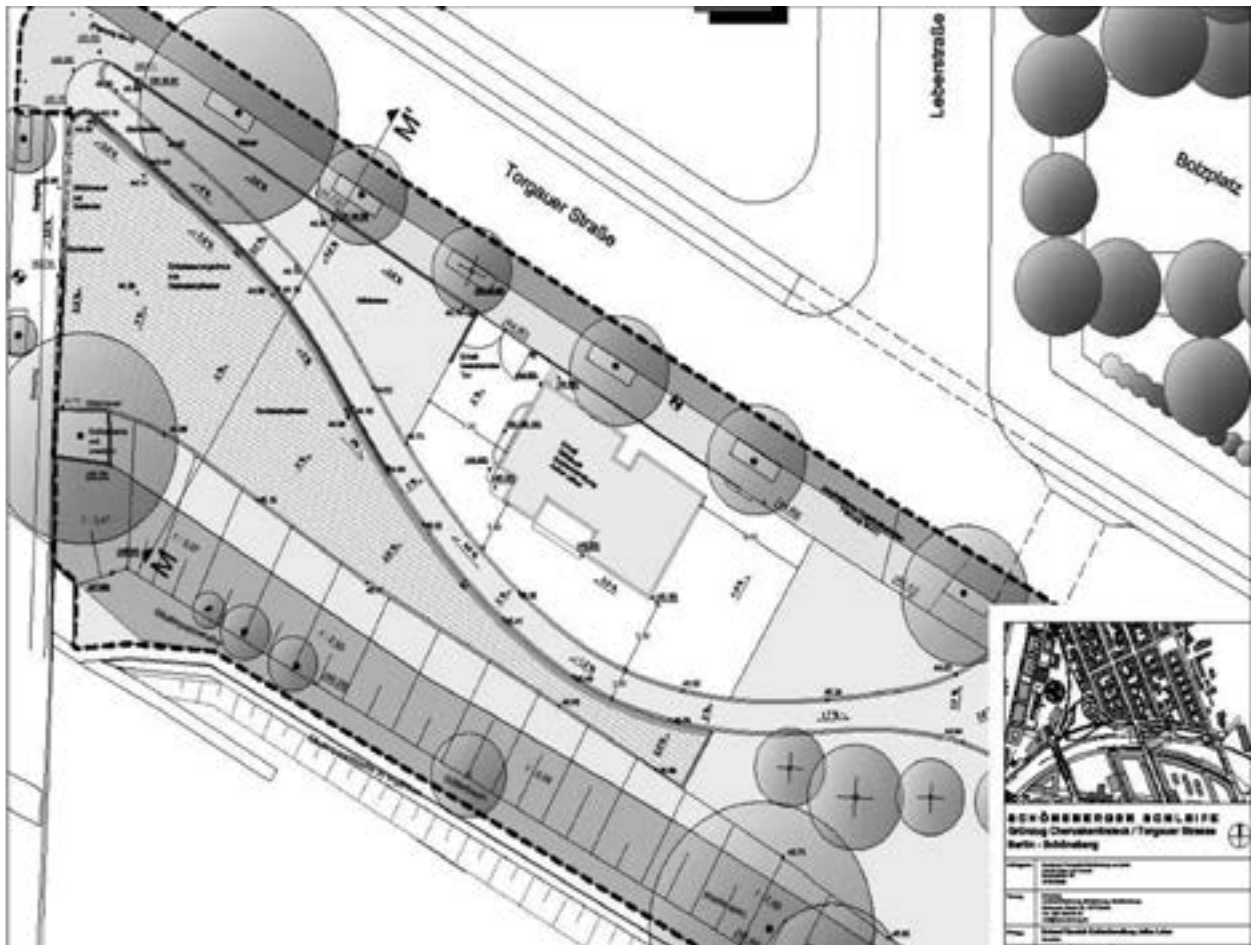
Entwurf Bereich Kohlenhandlung Julius Leber Grundriss
